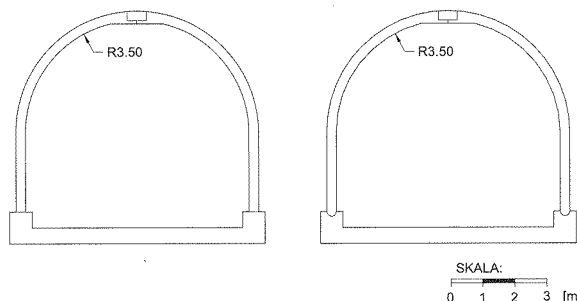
Konstrukcja typu Matiere o sekcji podwójnej (pierwsza cyfra w oznaczeniu to promień krzywizny elementów stóp w decymetrach, a druga – promień krzywizny sklepienia w decymetrach)
